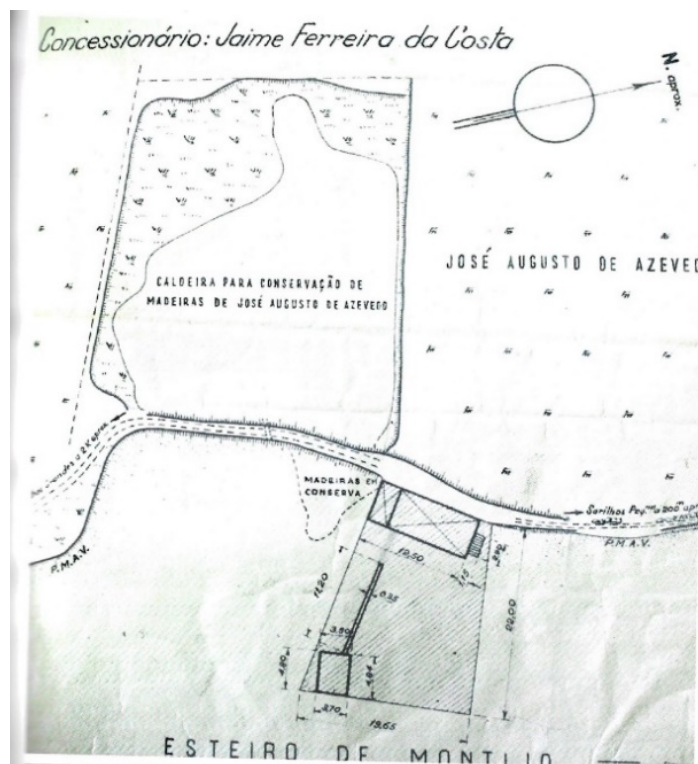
Planta da concessão feita a Jaime Ferreira da Costa, em 1956.
